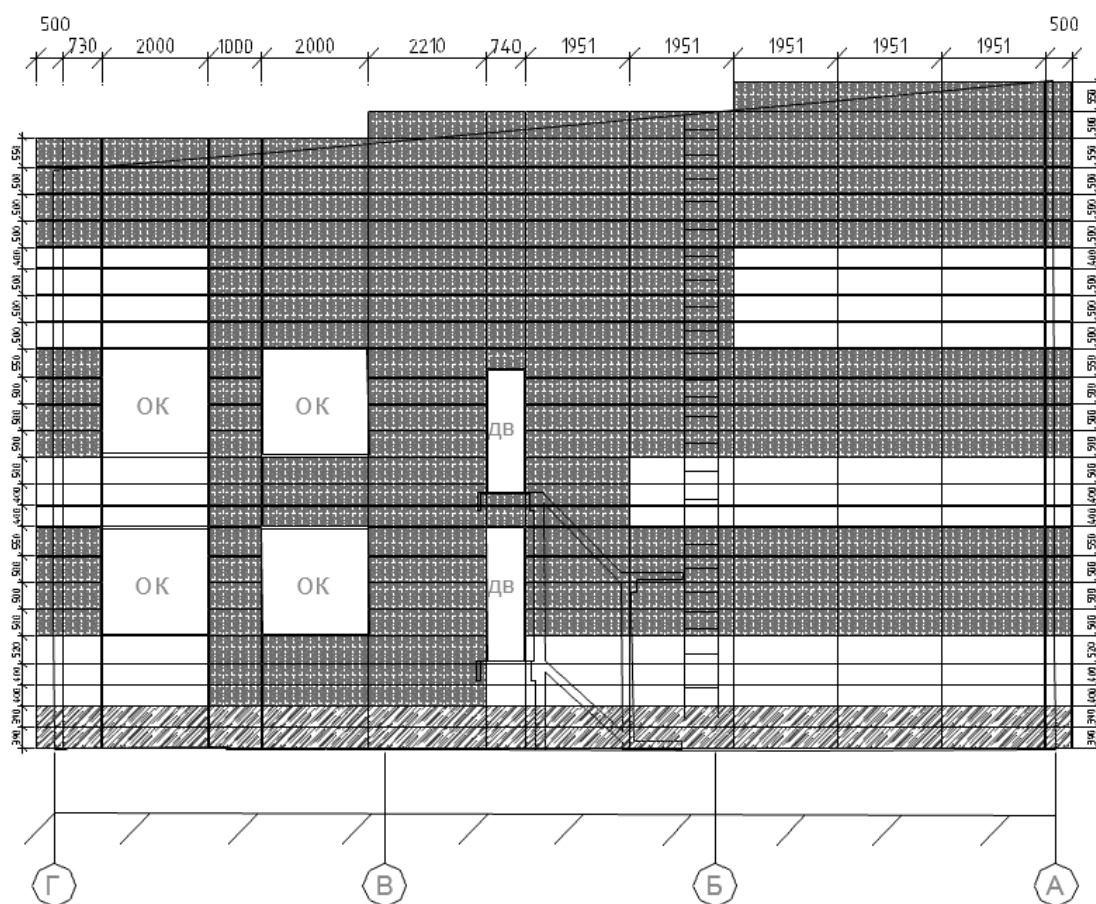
Раскладка кассет на фасаде в осях Г-А.
